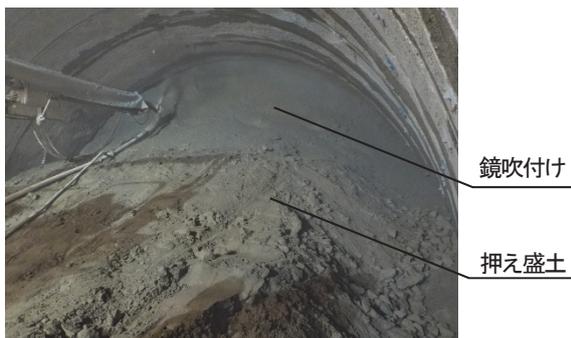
崩落状況 (押え盛土, 吹付コンクリート)
